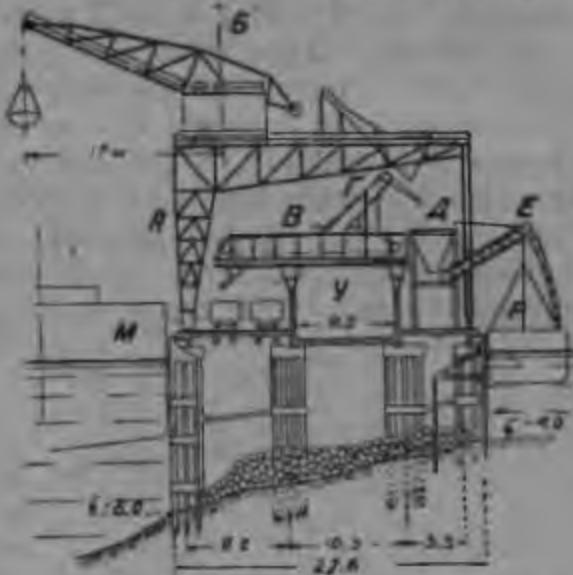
Поперечное сечение узкого мола в рыбачьем порту Лориан с оборудованием для перегрузки угля.
